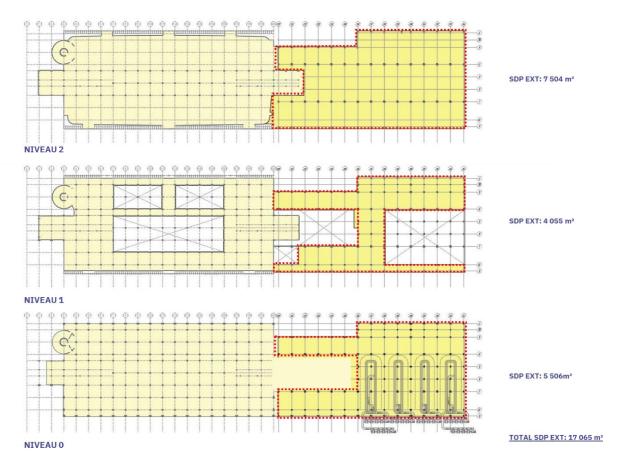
Emprise projet – Plan par niveau - Trame structurelle et emprise de l'existant (jaune pâle) et de l'extension (jaune)
